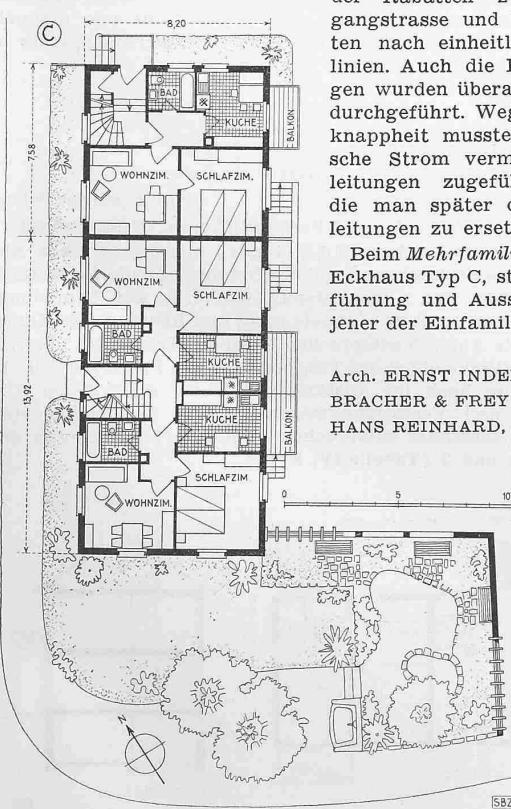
Erdgeschoss-Grundriss Typ C. — 1 : 300
